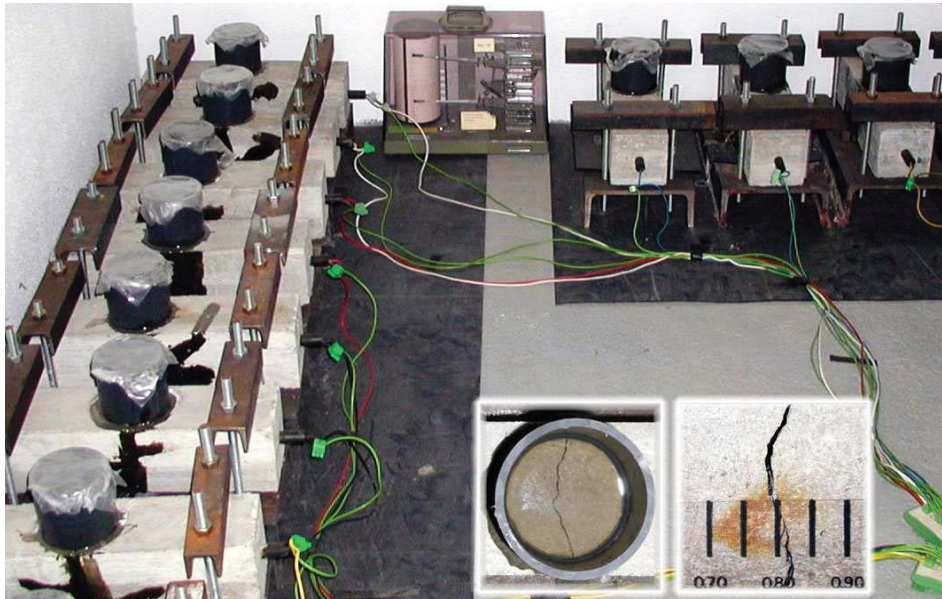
Montagem experimental desenvolvida para o estudo no betão fissurado.
